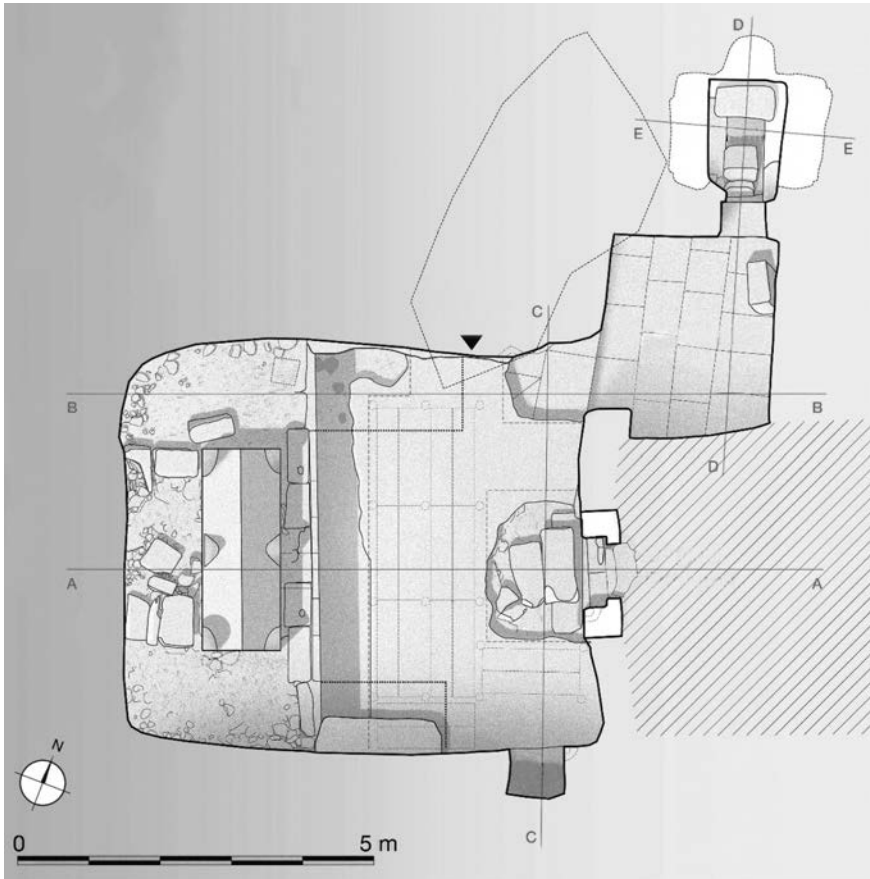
Plan au sol du Tombeau du Fondateur (© Soizik Bechetoille, Ifpo, 2019).
